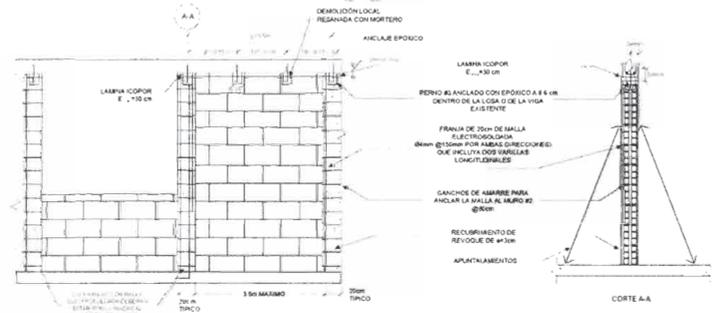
Refuerzo de muro existente con de revoque con malla.
